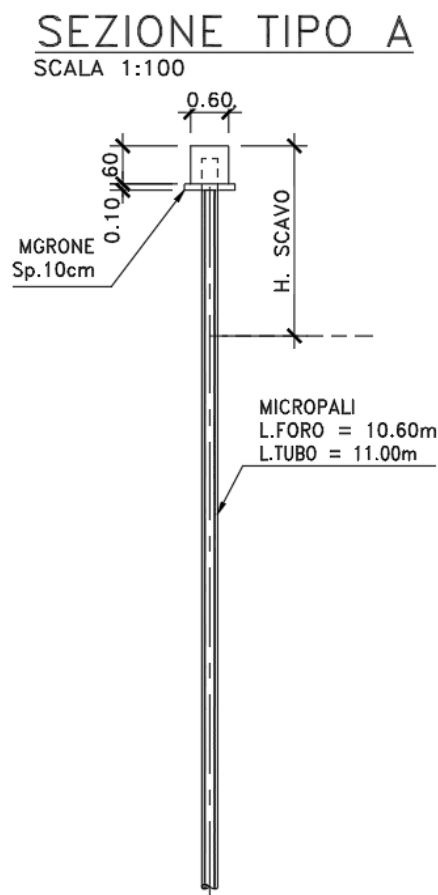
inserire prospetto e sezione delle paratie tipo A
